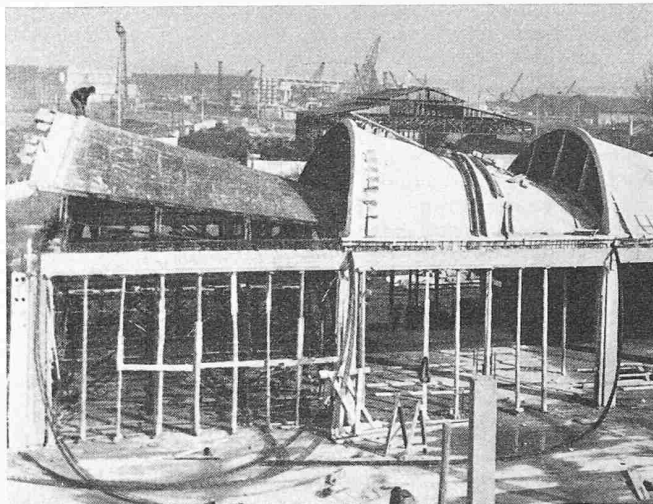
Oberflächenbehandlung von Betongewölben mit VC-Matten, Ausschallfrist 2 Tage (Bordeaux, Frankreich)
